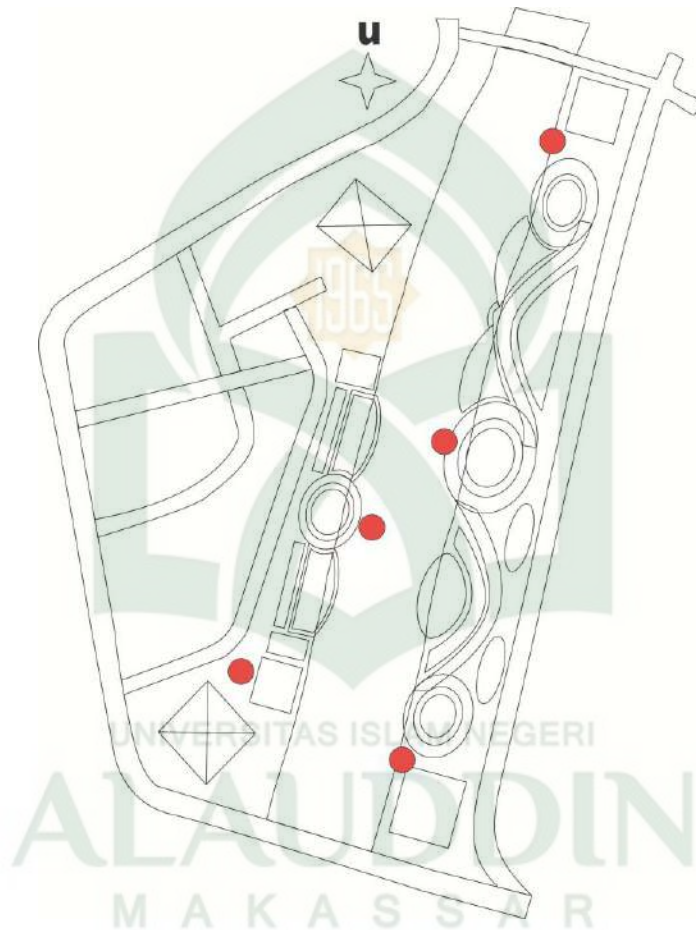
Perencanaan Sirkulasi Dan Parkir
